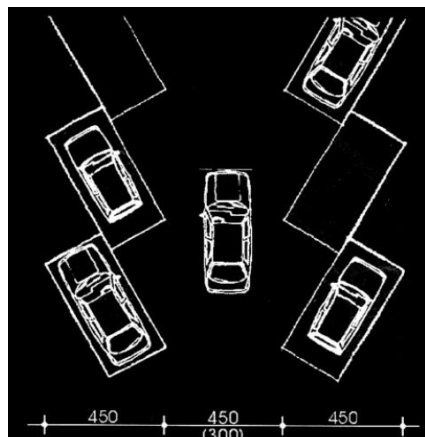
Základní rozměry parkovacího místa v Itálii [11]
